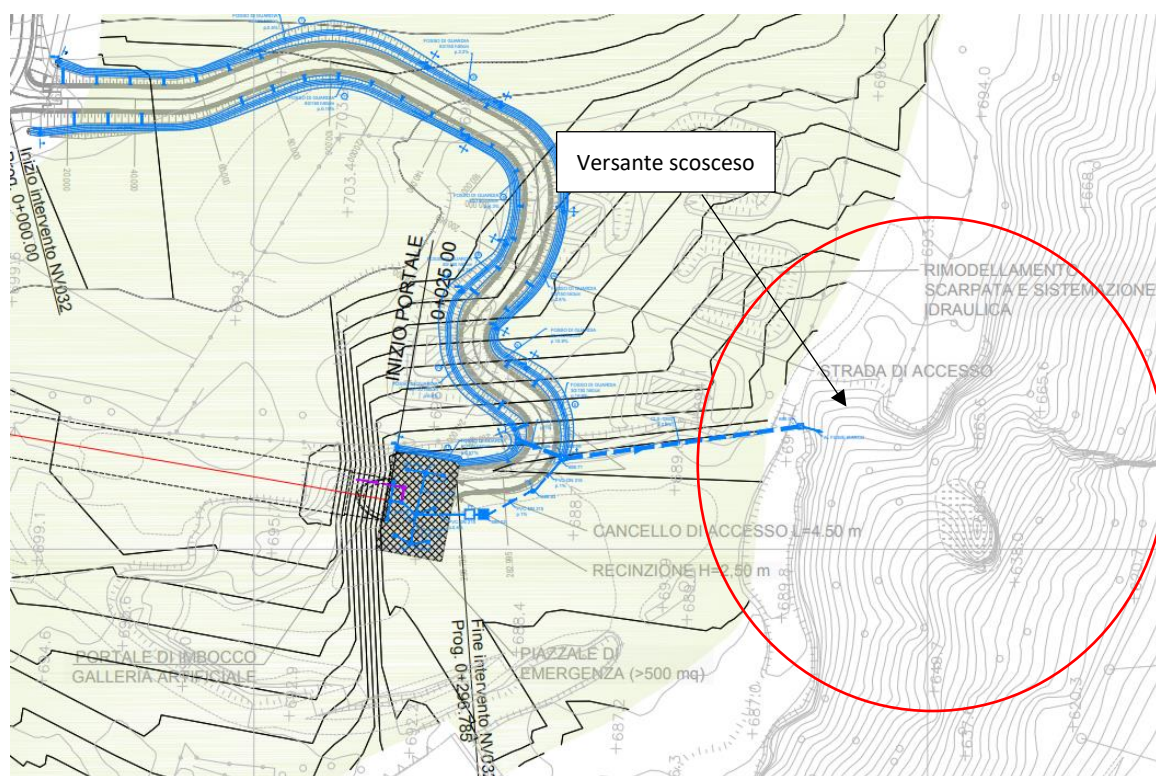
Planimetria idraulica NV032 con recapito sul versante (PD)
